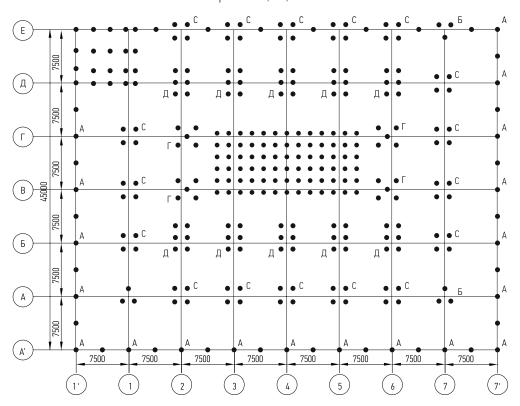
Схема расположения свай при варианте монолитного железобетонного каркаса с сеткой 7,5х7,5 м
